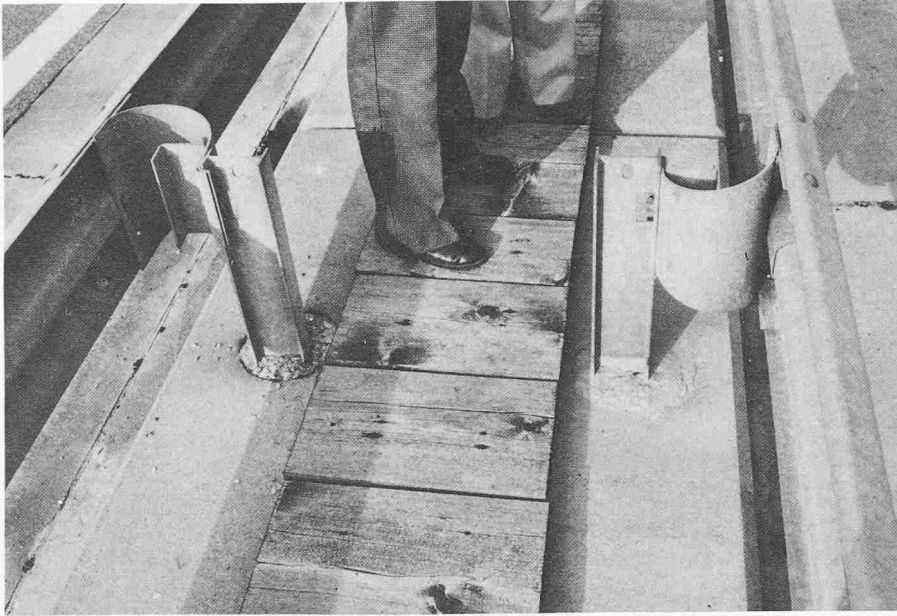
Die Leitplanken überragen den Brückenrand. Detail Pfostenanschluss rechts: Inbetriebsetzung des Objekts 1971. Pfostenanschlüsse mit Efkaprene im Jahre 1975 beschichtet, das heisst 4 Jahre vor und 5 Jahre nach der Beschichtung dem Tausalz ausgesetzt. Beispiel an der N5 (Aufnahme: 1980)
